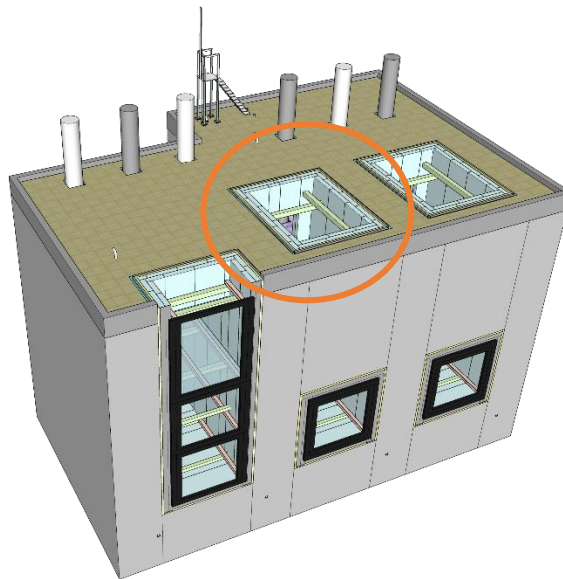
Plan 3D de l'équipement échelle 1 de Tipee
